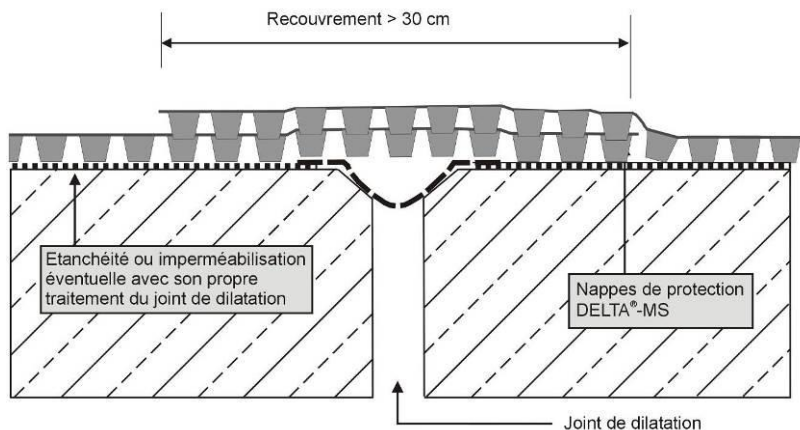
DELTA®-MS – coupe horizontale d'un joint de dilatation
